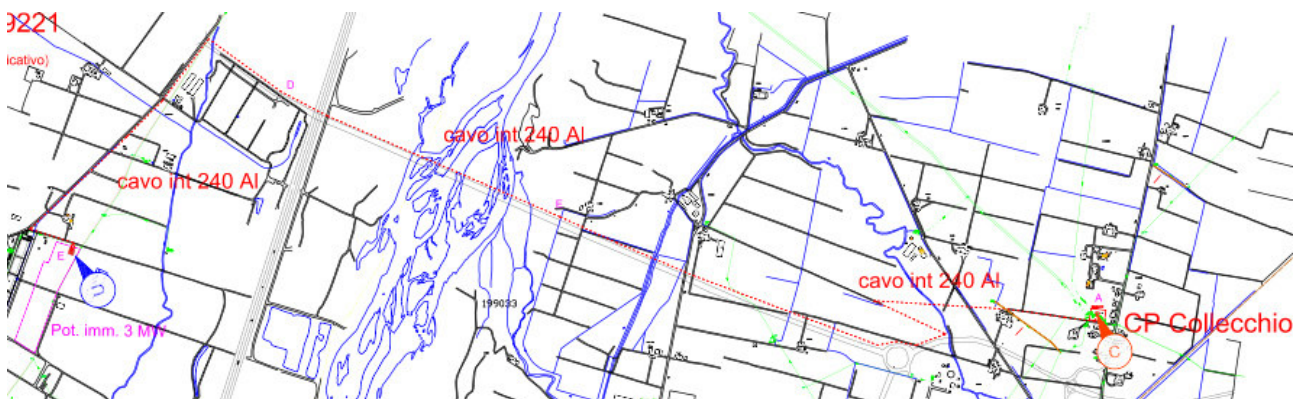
planimetria della soluzione di connessione (dal preventivo di E-Distribuzione)
